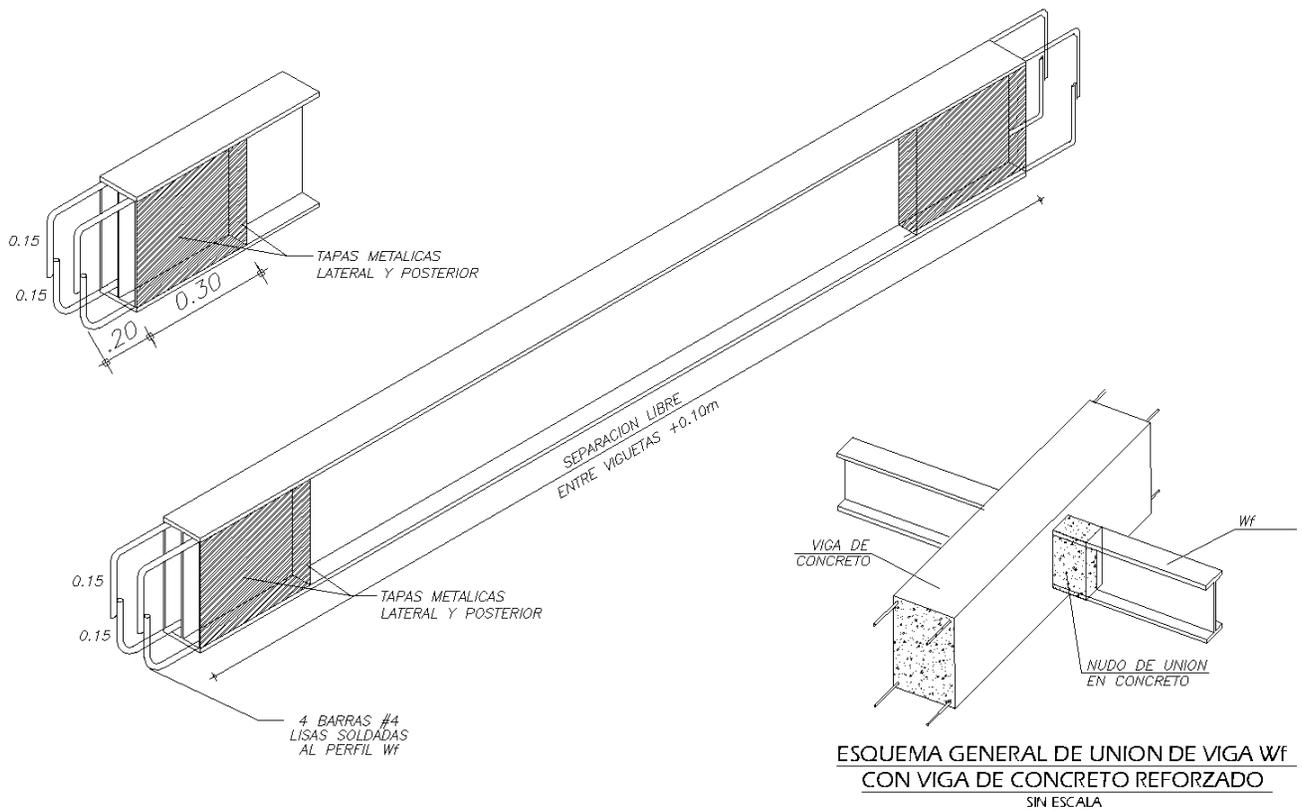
ANCLAJE NUDO VIGA VIGUETA
